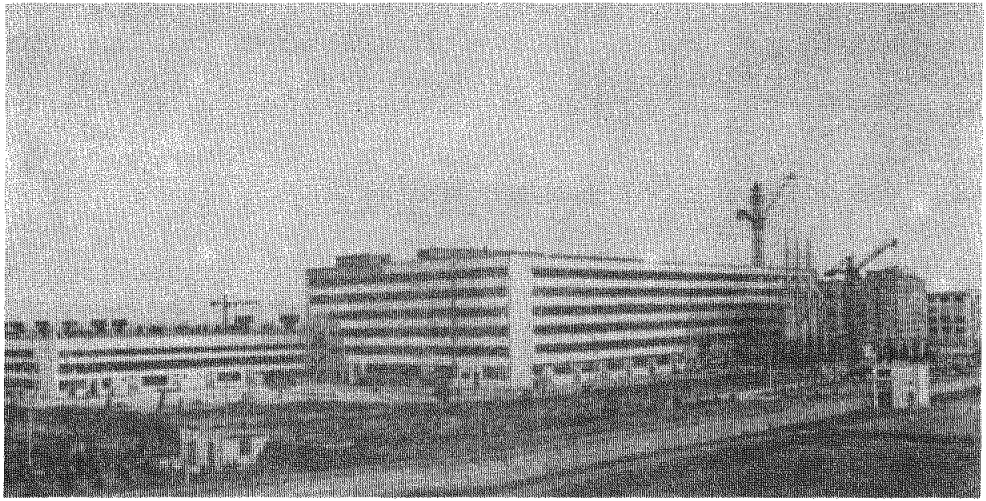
Многоэтажные производственные здания с "открытым" фасадом
